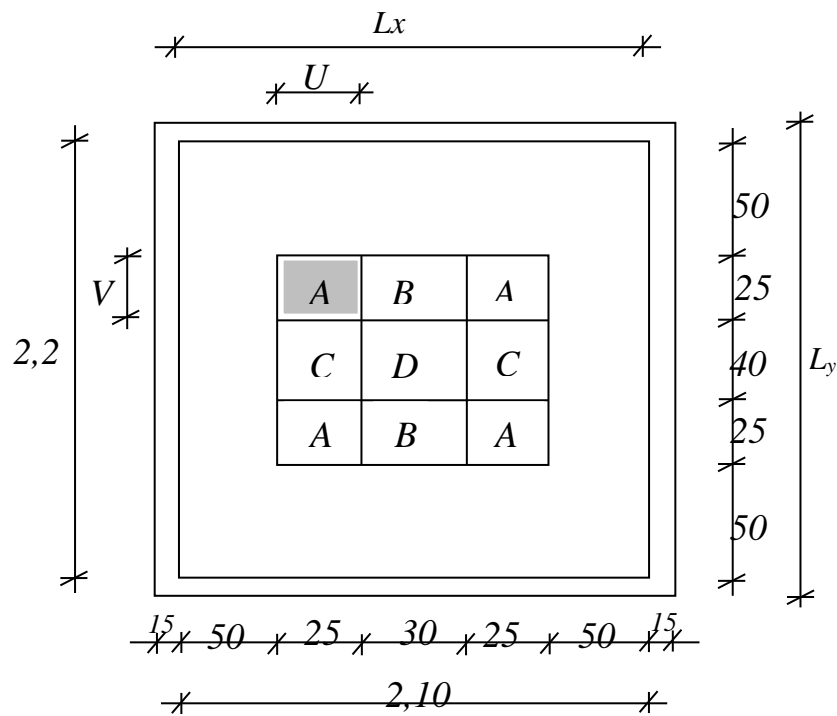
Schéma de la dalle pleine d'ascenseur.
